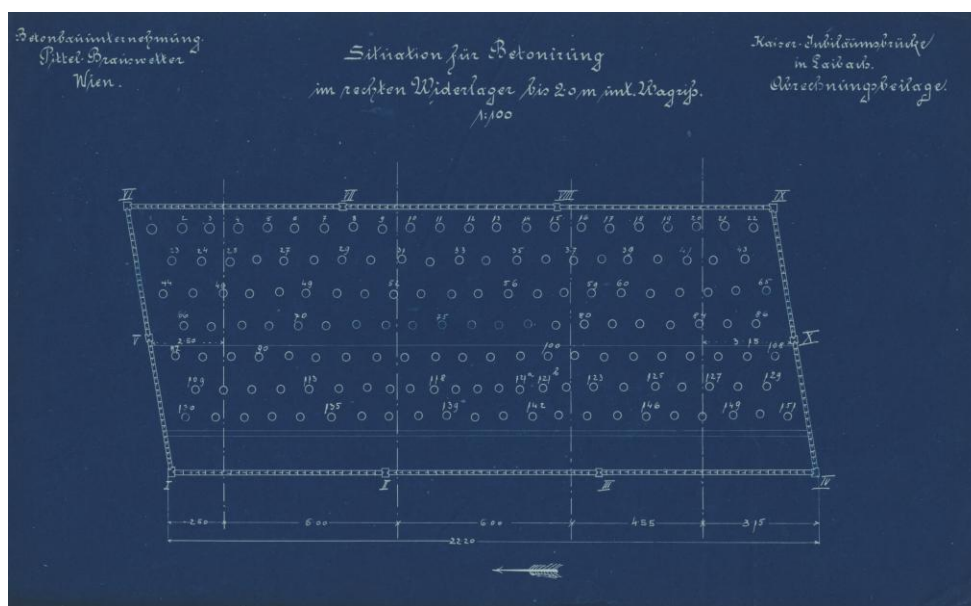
Tloris lesenih pilotov, ki nosijo betonske temelje
